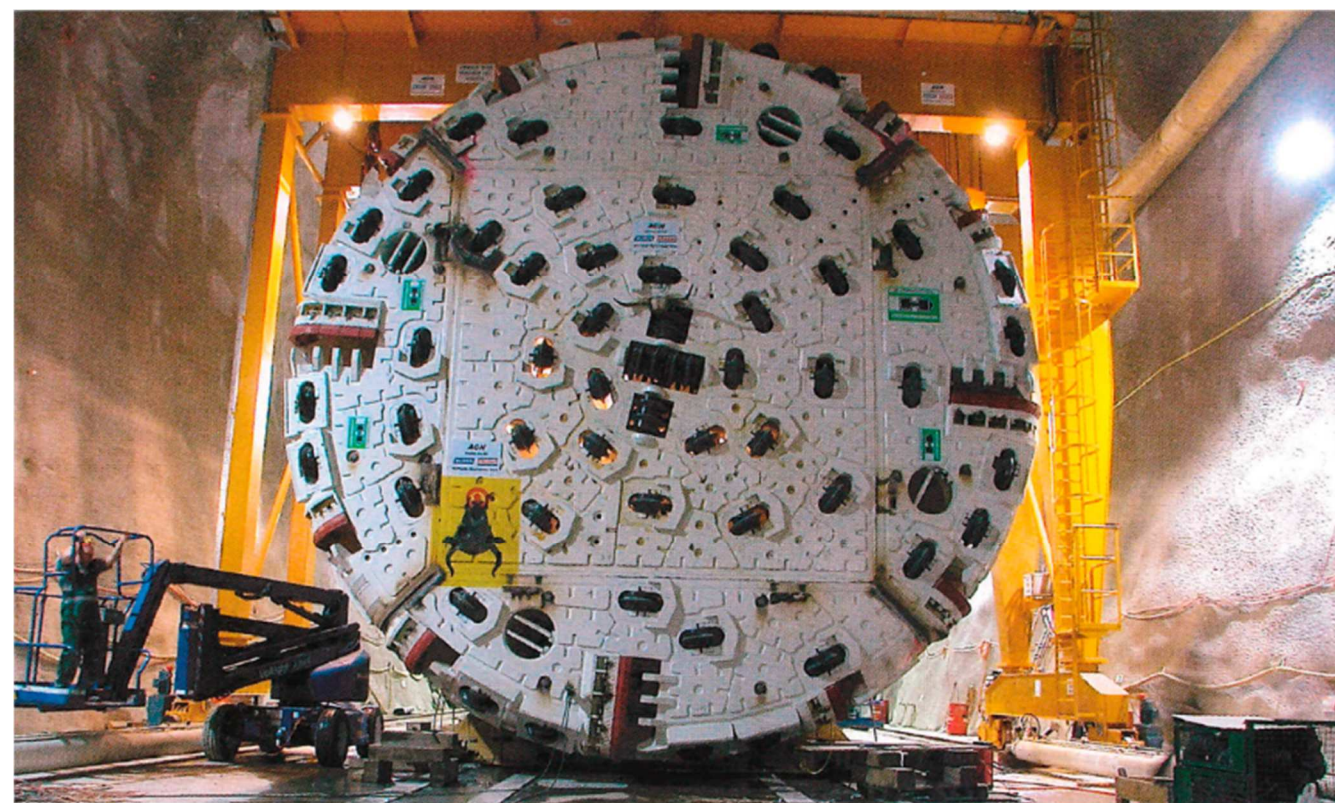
a.- Sección a excavar con una tuneladora.
